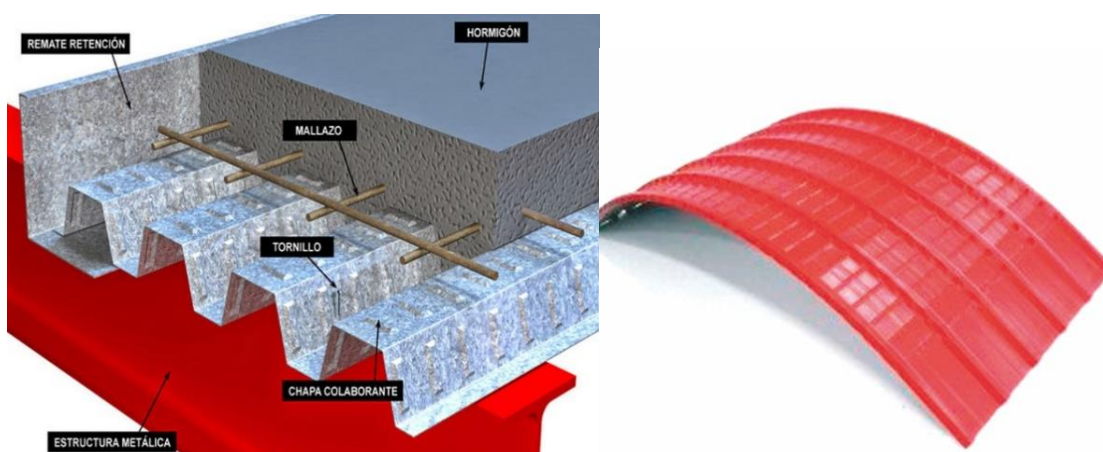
Steel deck o losa colaborante y calaminon alucín tr4
